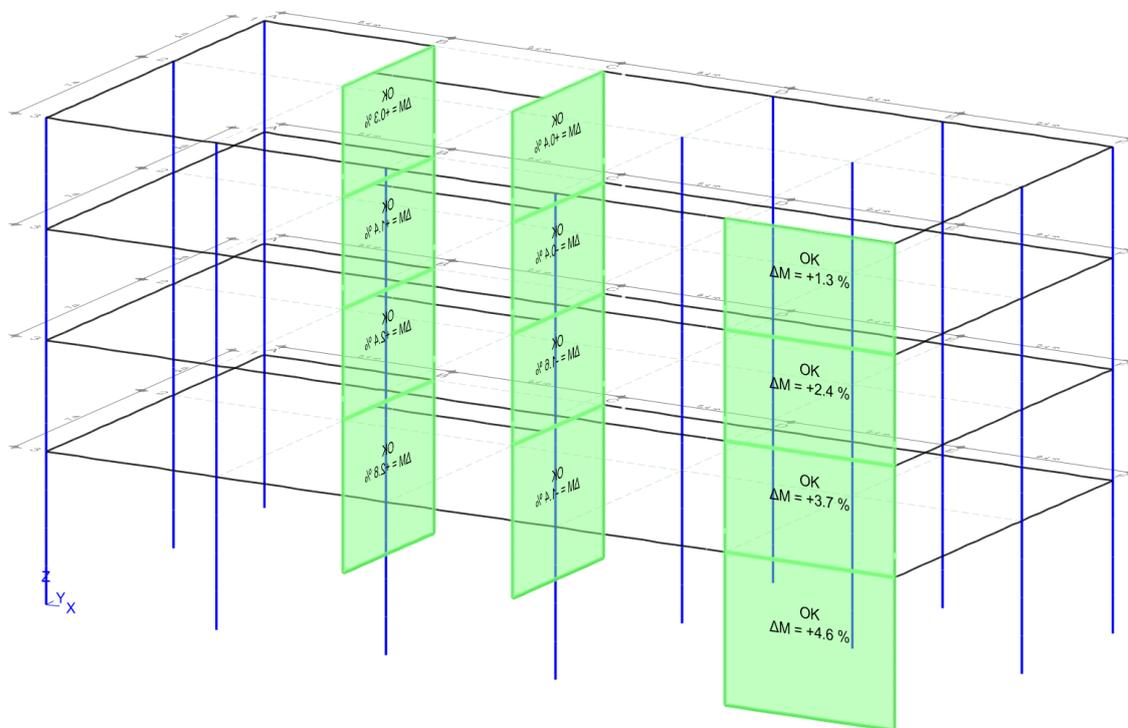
Nachweis der Aussteifung für unregelmäßige Grundrissgeometrien
